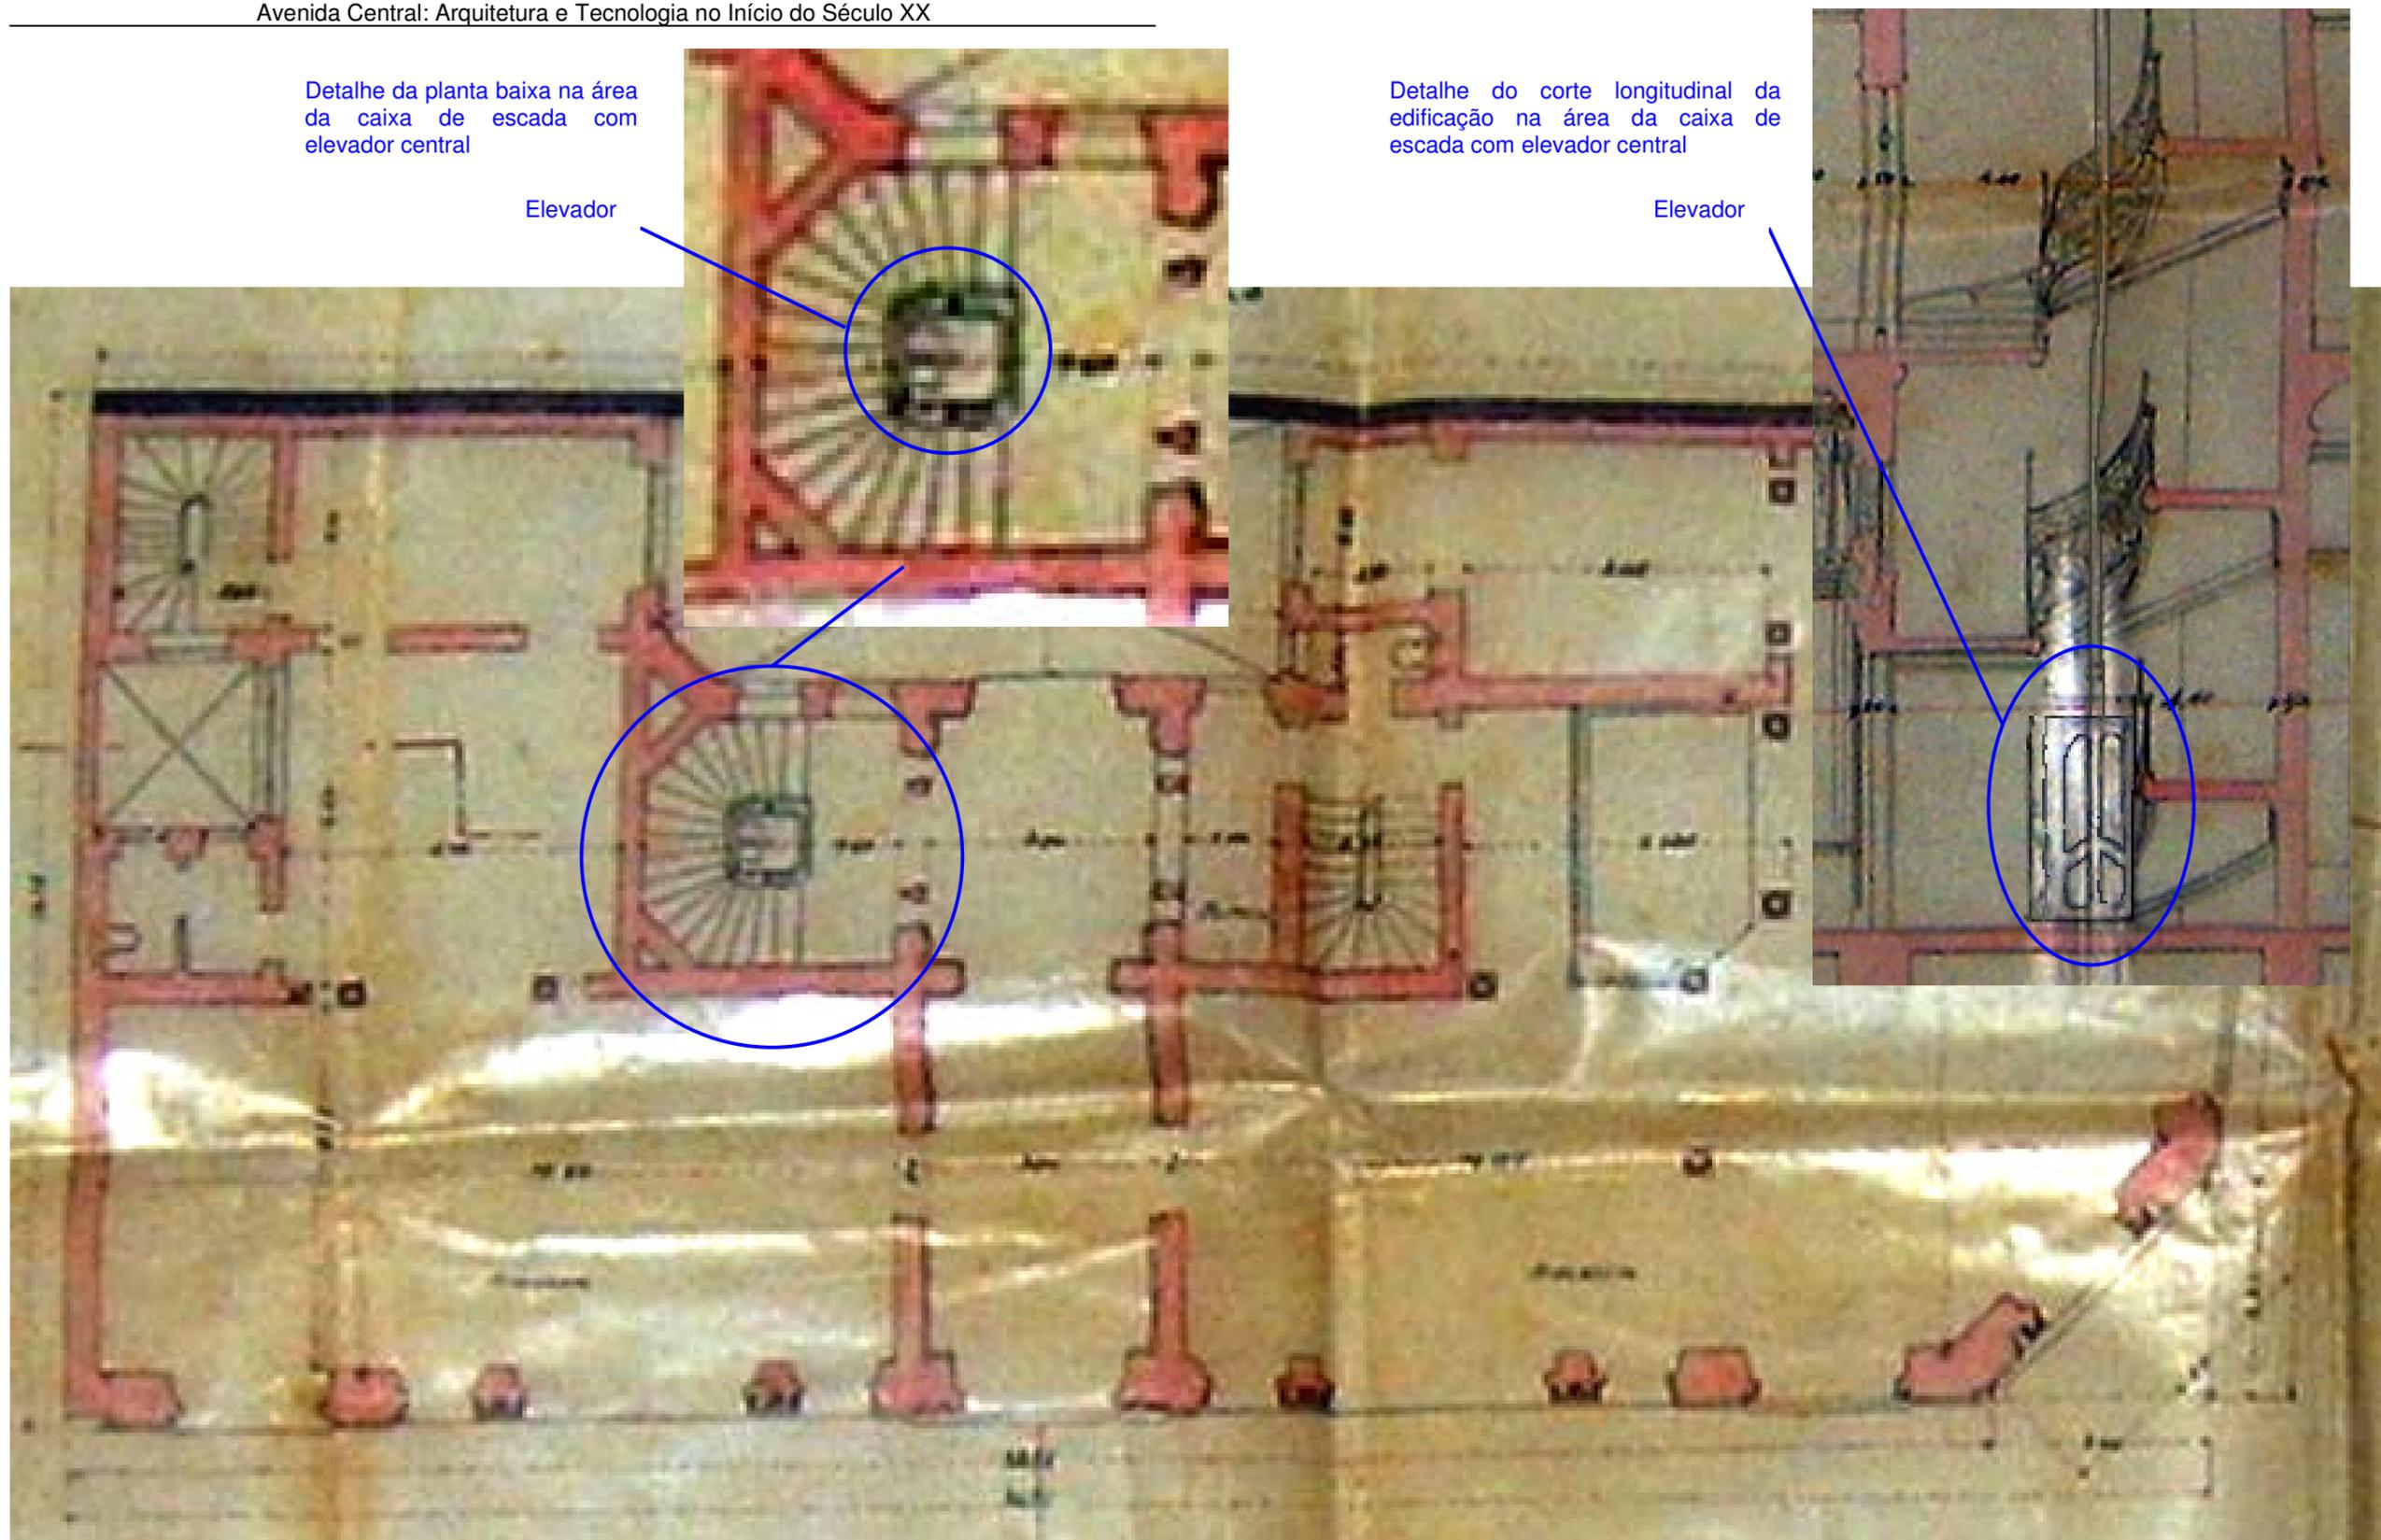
Planta baixa do pavimento térreo do prédio das Docas de Santos, nº 44 a 48 da Avenida. Nos detalhes, ampliação da caixa de escada, contendo um elevador central e do corte longitudinal, na área da escada e elevador.
